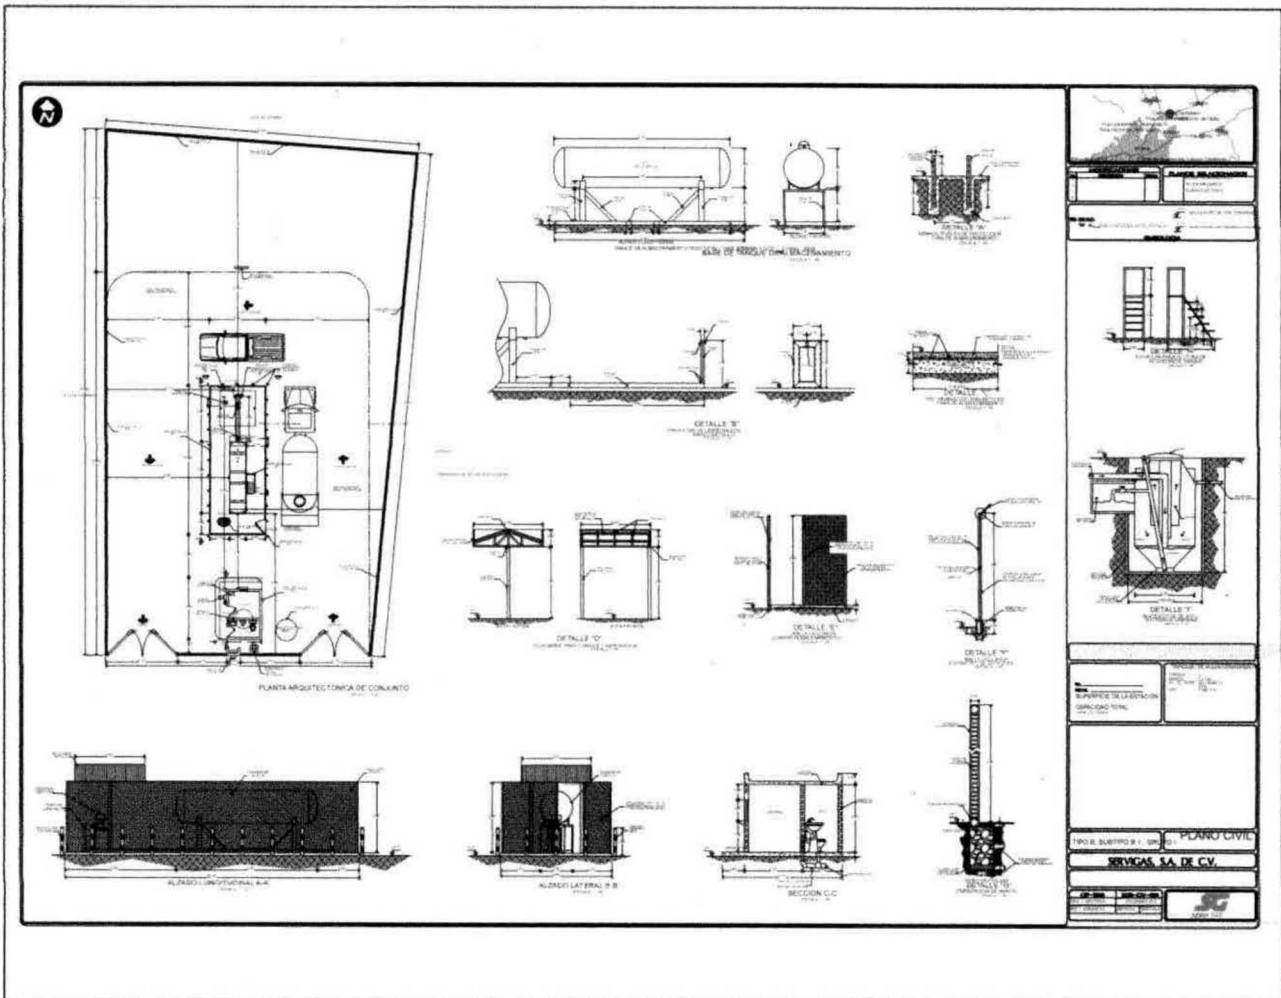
Planta de conjunto del proyecto (plano civil)
